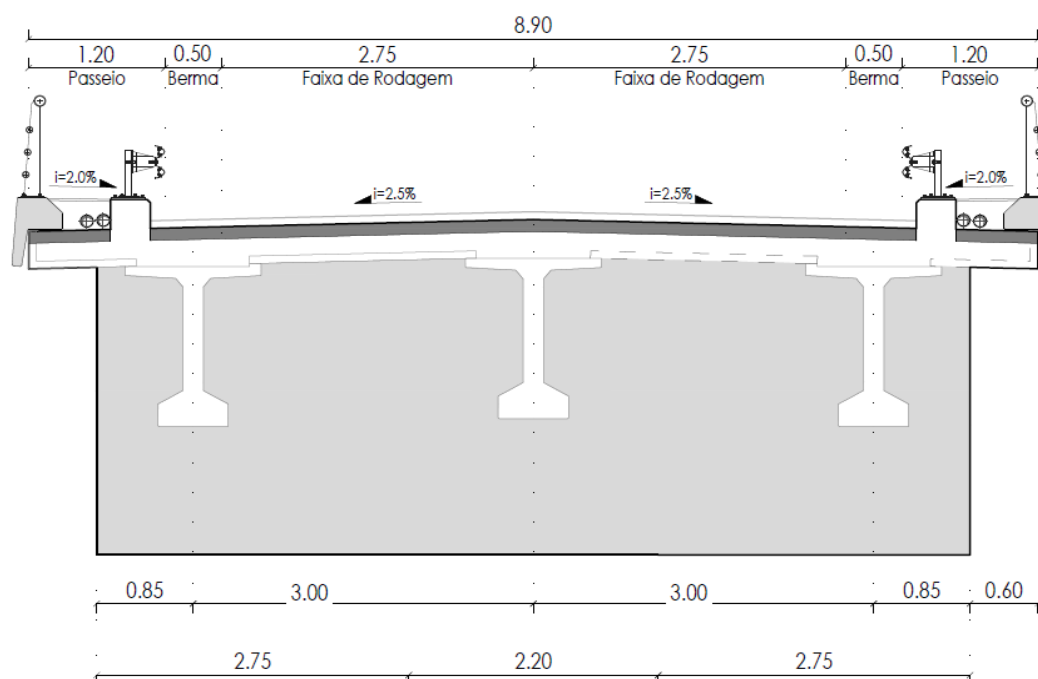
Secção transversal dos pilares (Ascendi, 2011)
